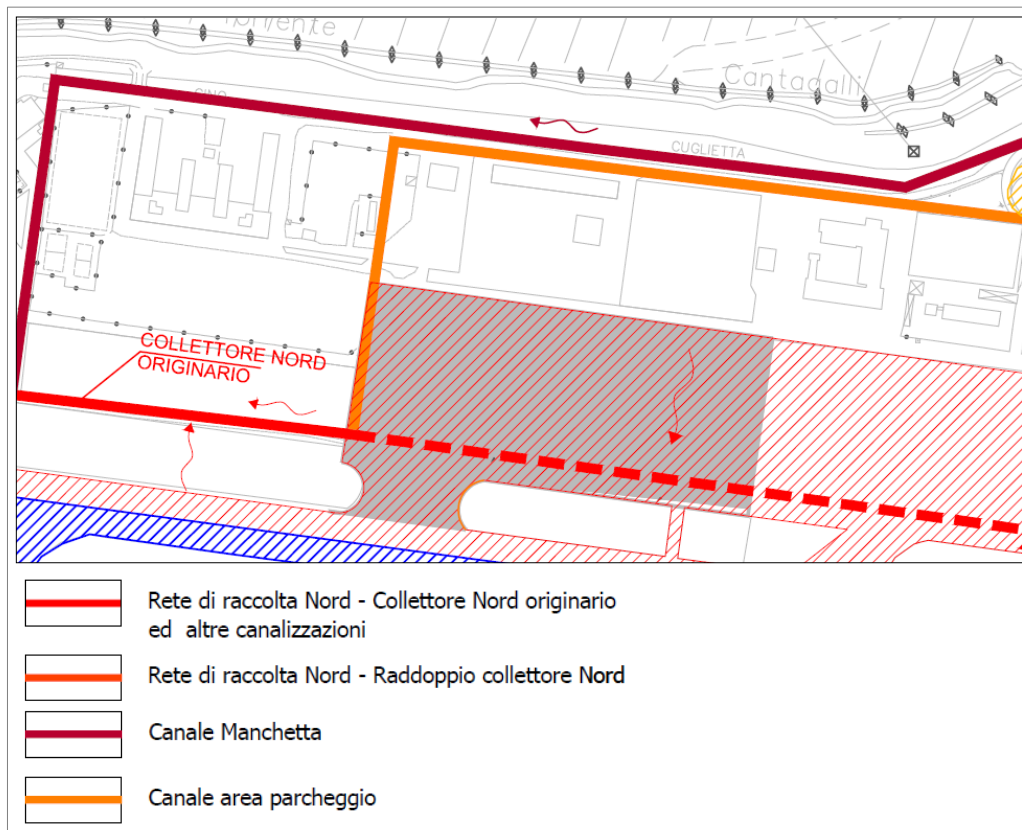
Planimetria idraulica del progetto piazzale aeromobili
